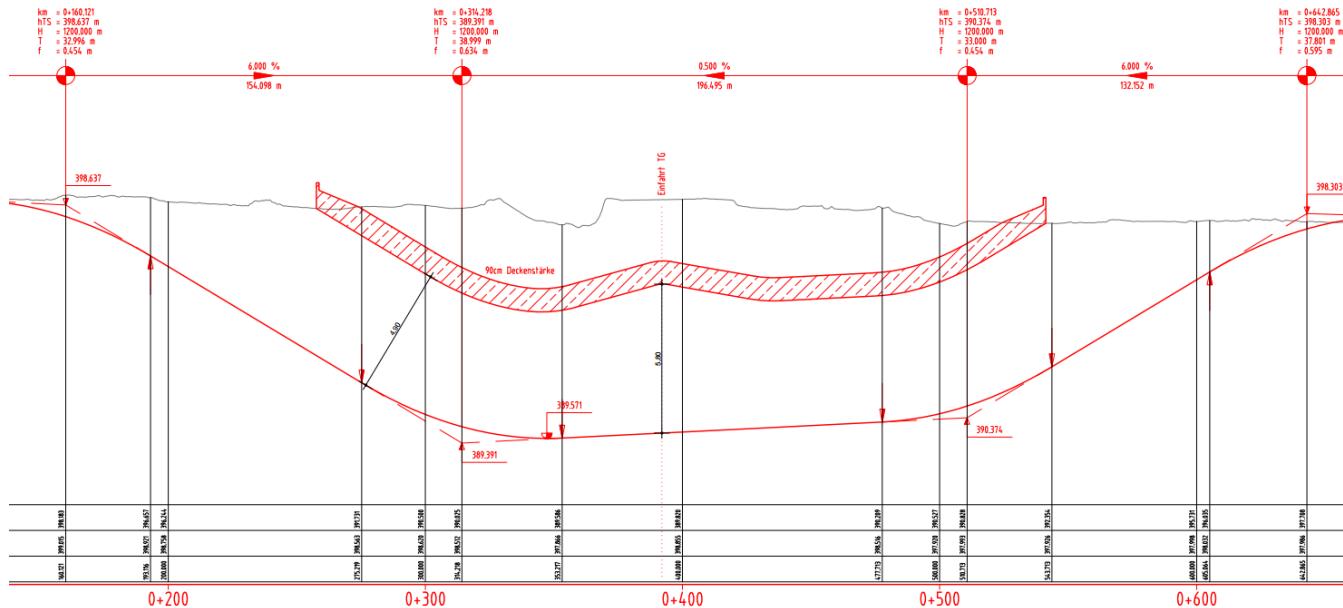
Ausschnitt Längenschnitt Variante 3 – kurzer Tunnel
